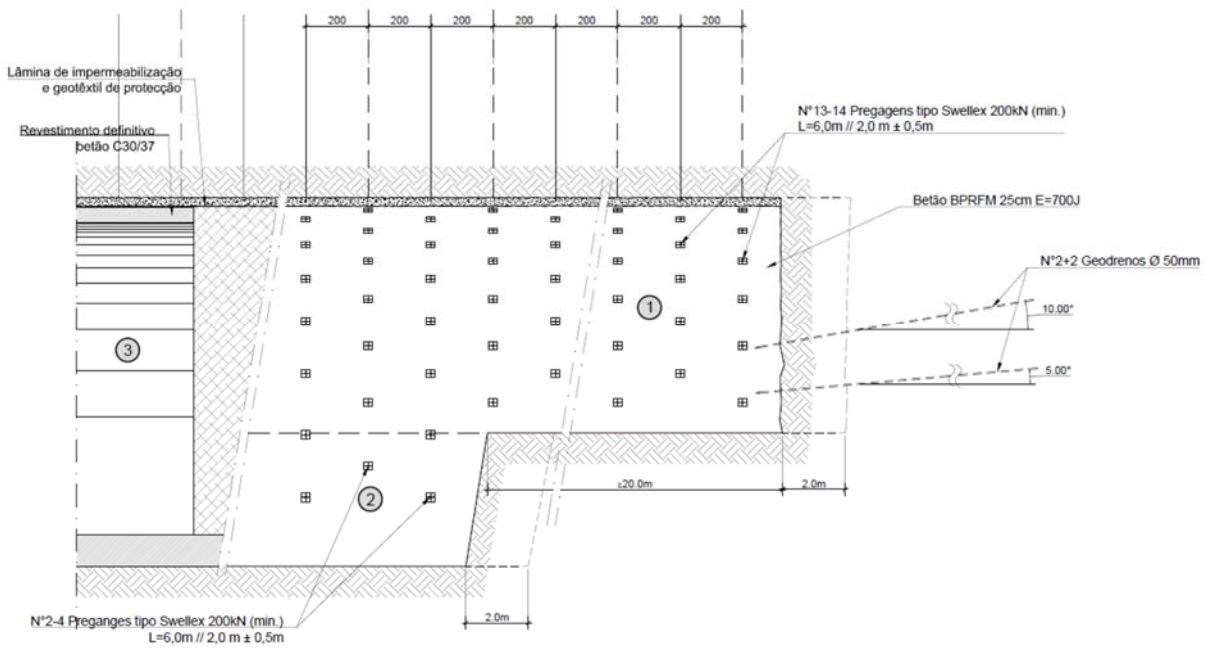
Corte longitudinal fase 1 e 2 – escavação e suporte primário em ZG1
